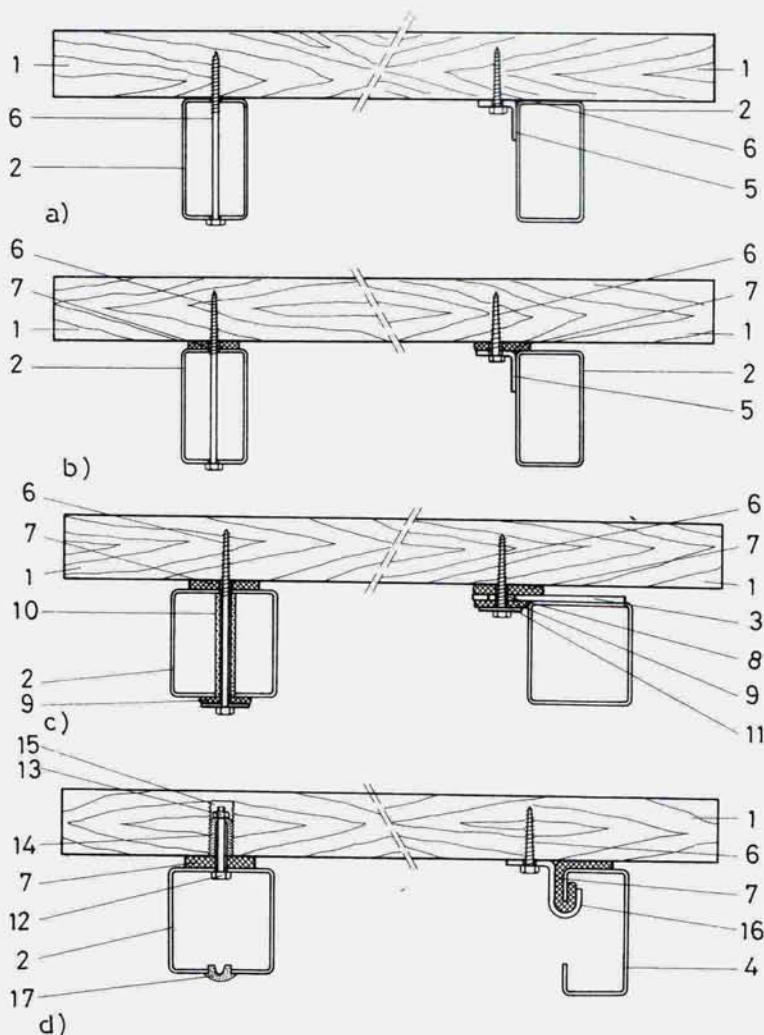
Виды крепления деревянных ступеней к стальным опорным конструкциям
